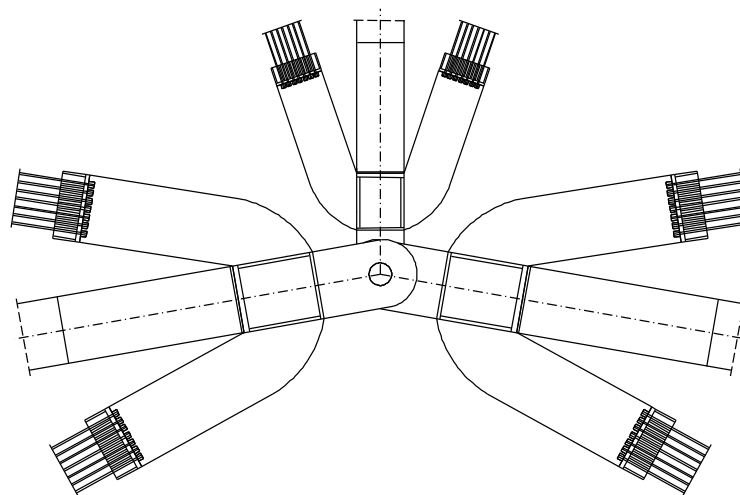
Esquema de ligação entre troços do arco e pilares de apoio à viga do tabuleiro.
